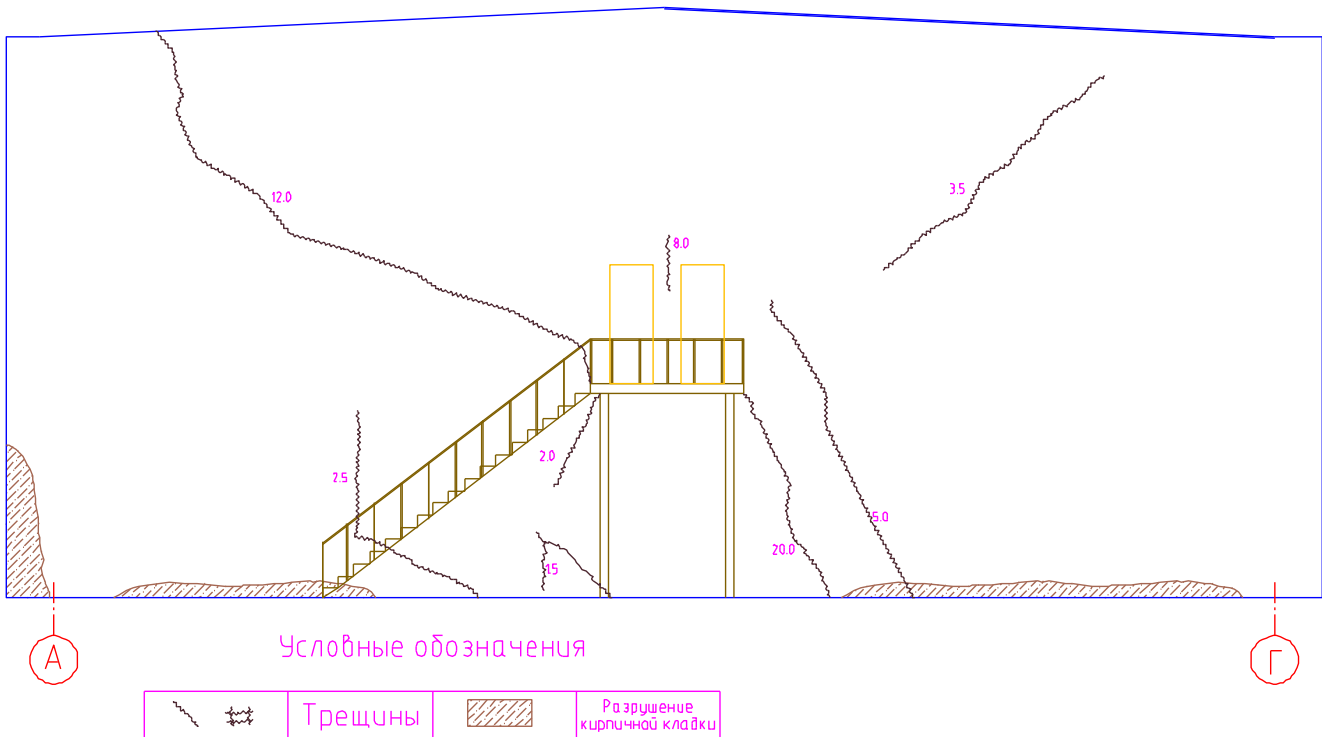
Дефектная карта фасада каменного здания (пример)
